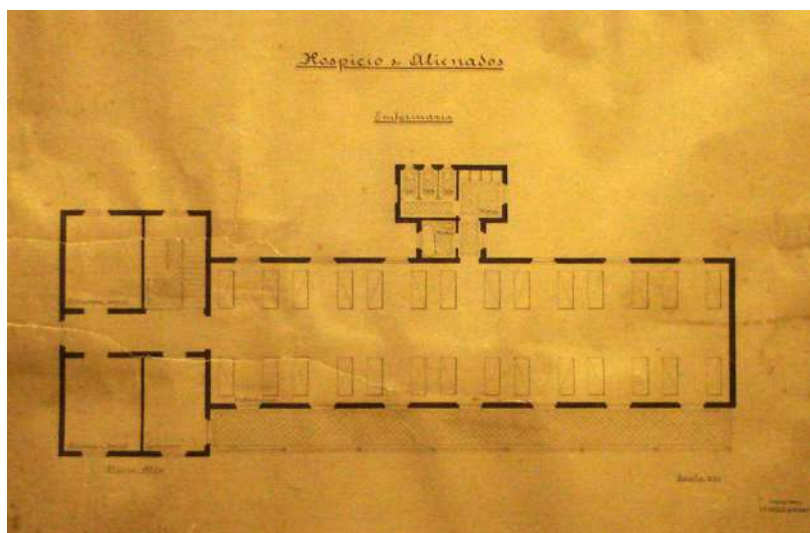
e 249 – Plantas e elevações do pavilhão de enfermaria (acervo do Museu Osório César);
